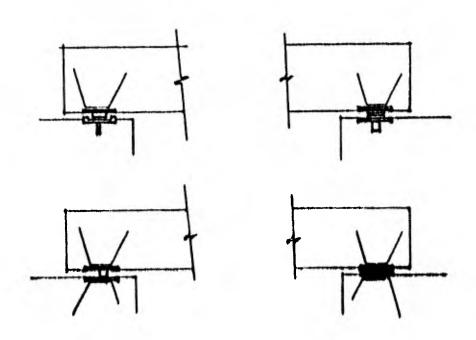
FIG. T. S. ADOYOG OF PLACAS PLANAS OF ACERO
